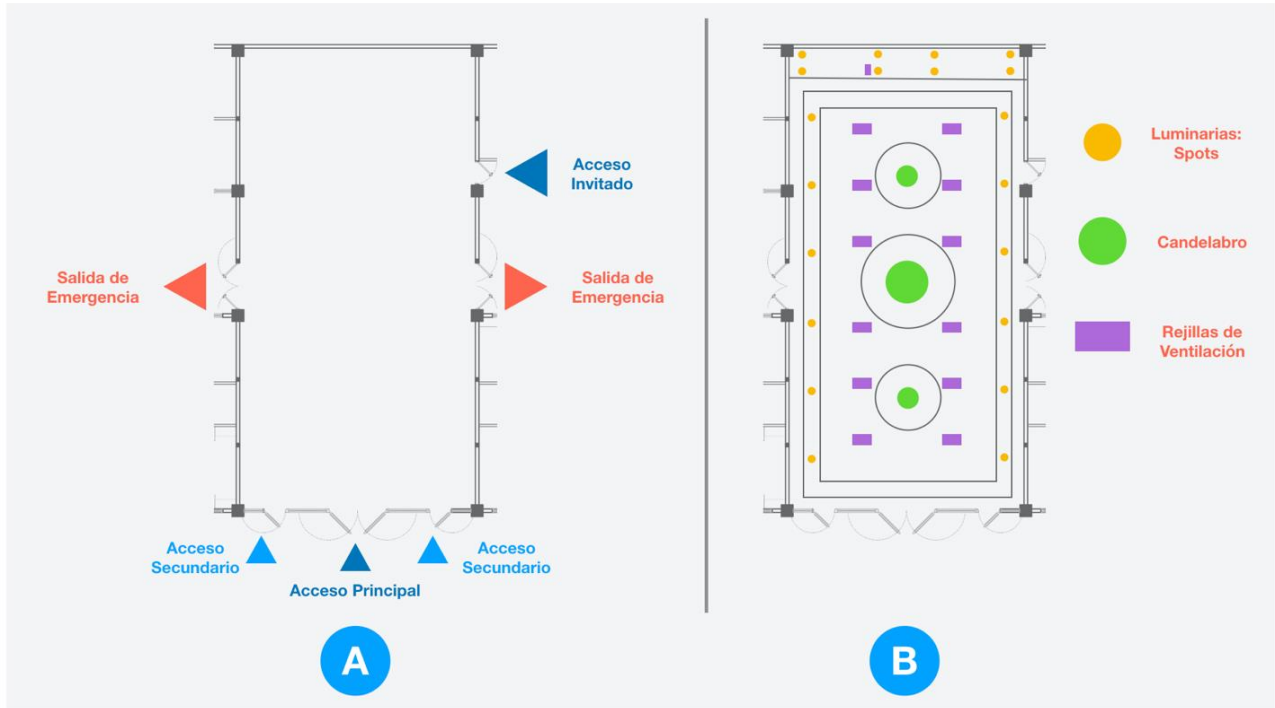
A: Planta de accesos, B: Planta de cielo falso
